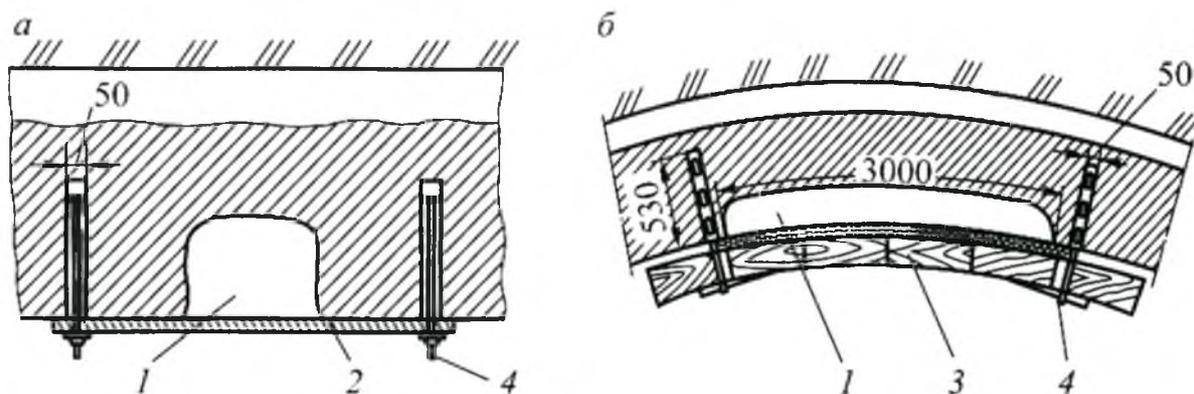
Подкрепление кладки обделки тоннеля:
